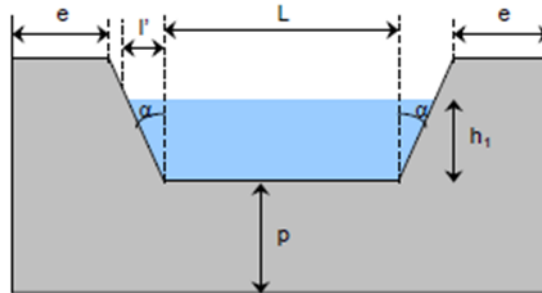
Coupe transversale d'un déversoir trapézoïdal
